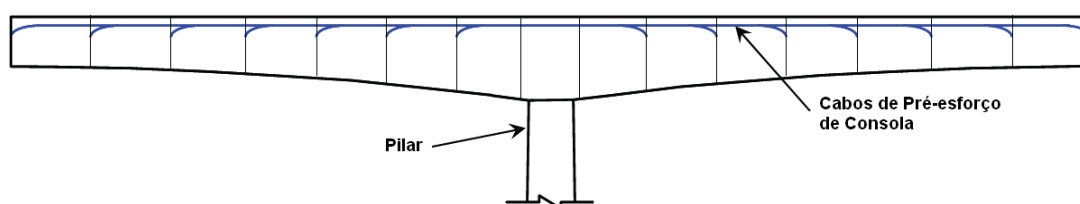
Traçado dos cabos de pré-esforço na construção por avanços sucessivos.
